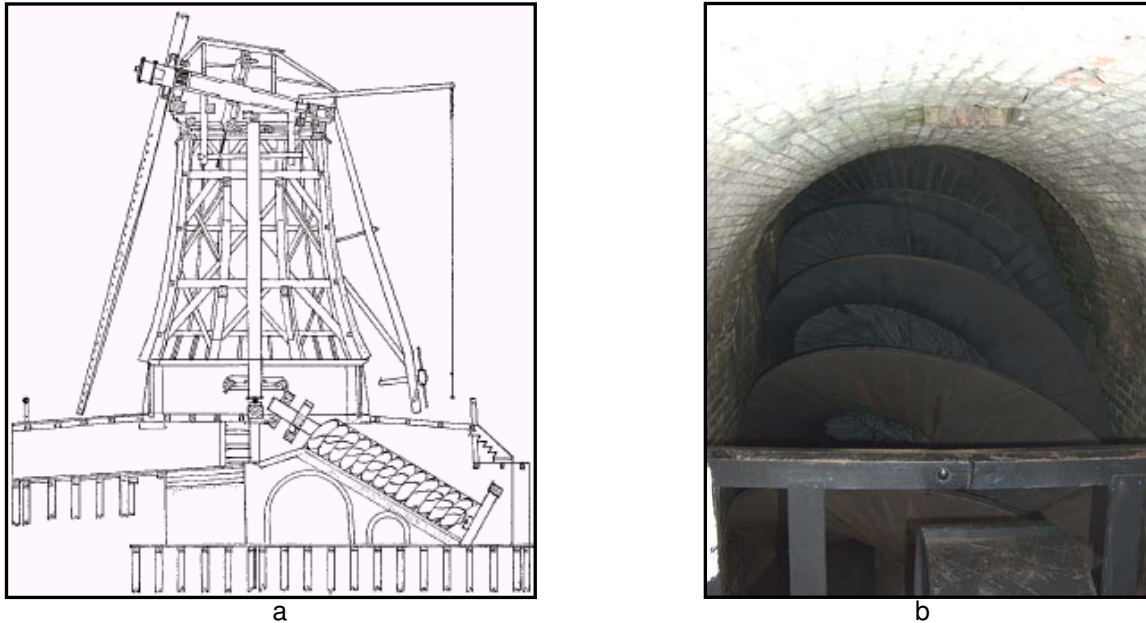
a. Querschnitt einer Mühle mit Archimedesschraube [31] und b. Archimedesschraube in bestehender Mühle [Foto L. Frossard]
